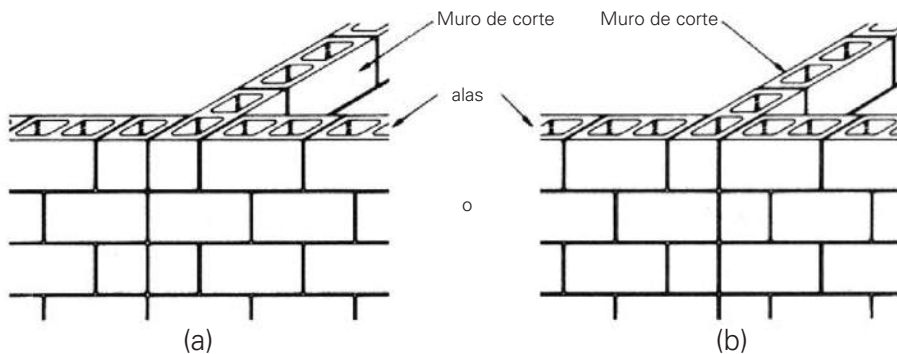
a. Intersección con mampostería traslapada (TMS 402-08).
